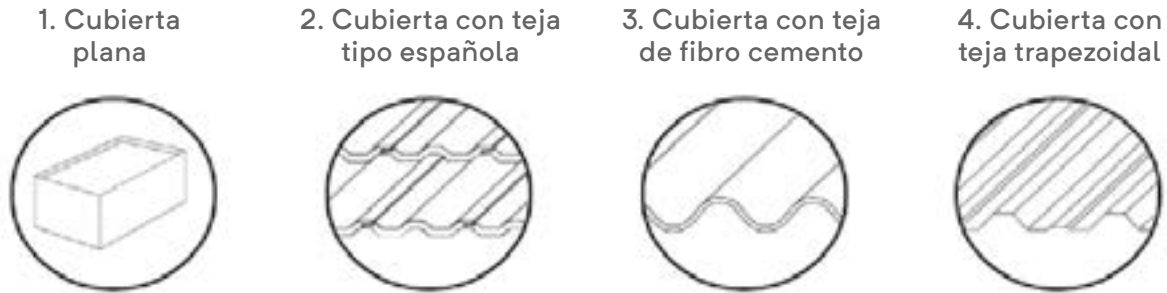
Tipos de estructura para la instalación de paneles solares en edificaciones
